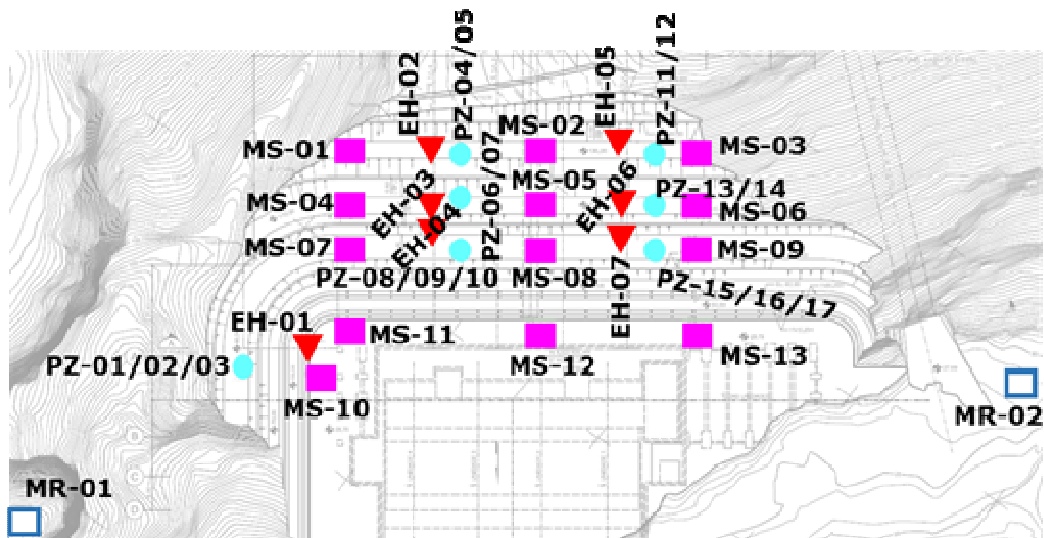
Localização dos dispositivos de instrumentação e observação da escavação da central
